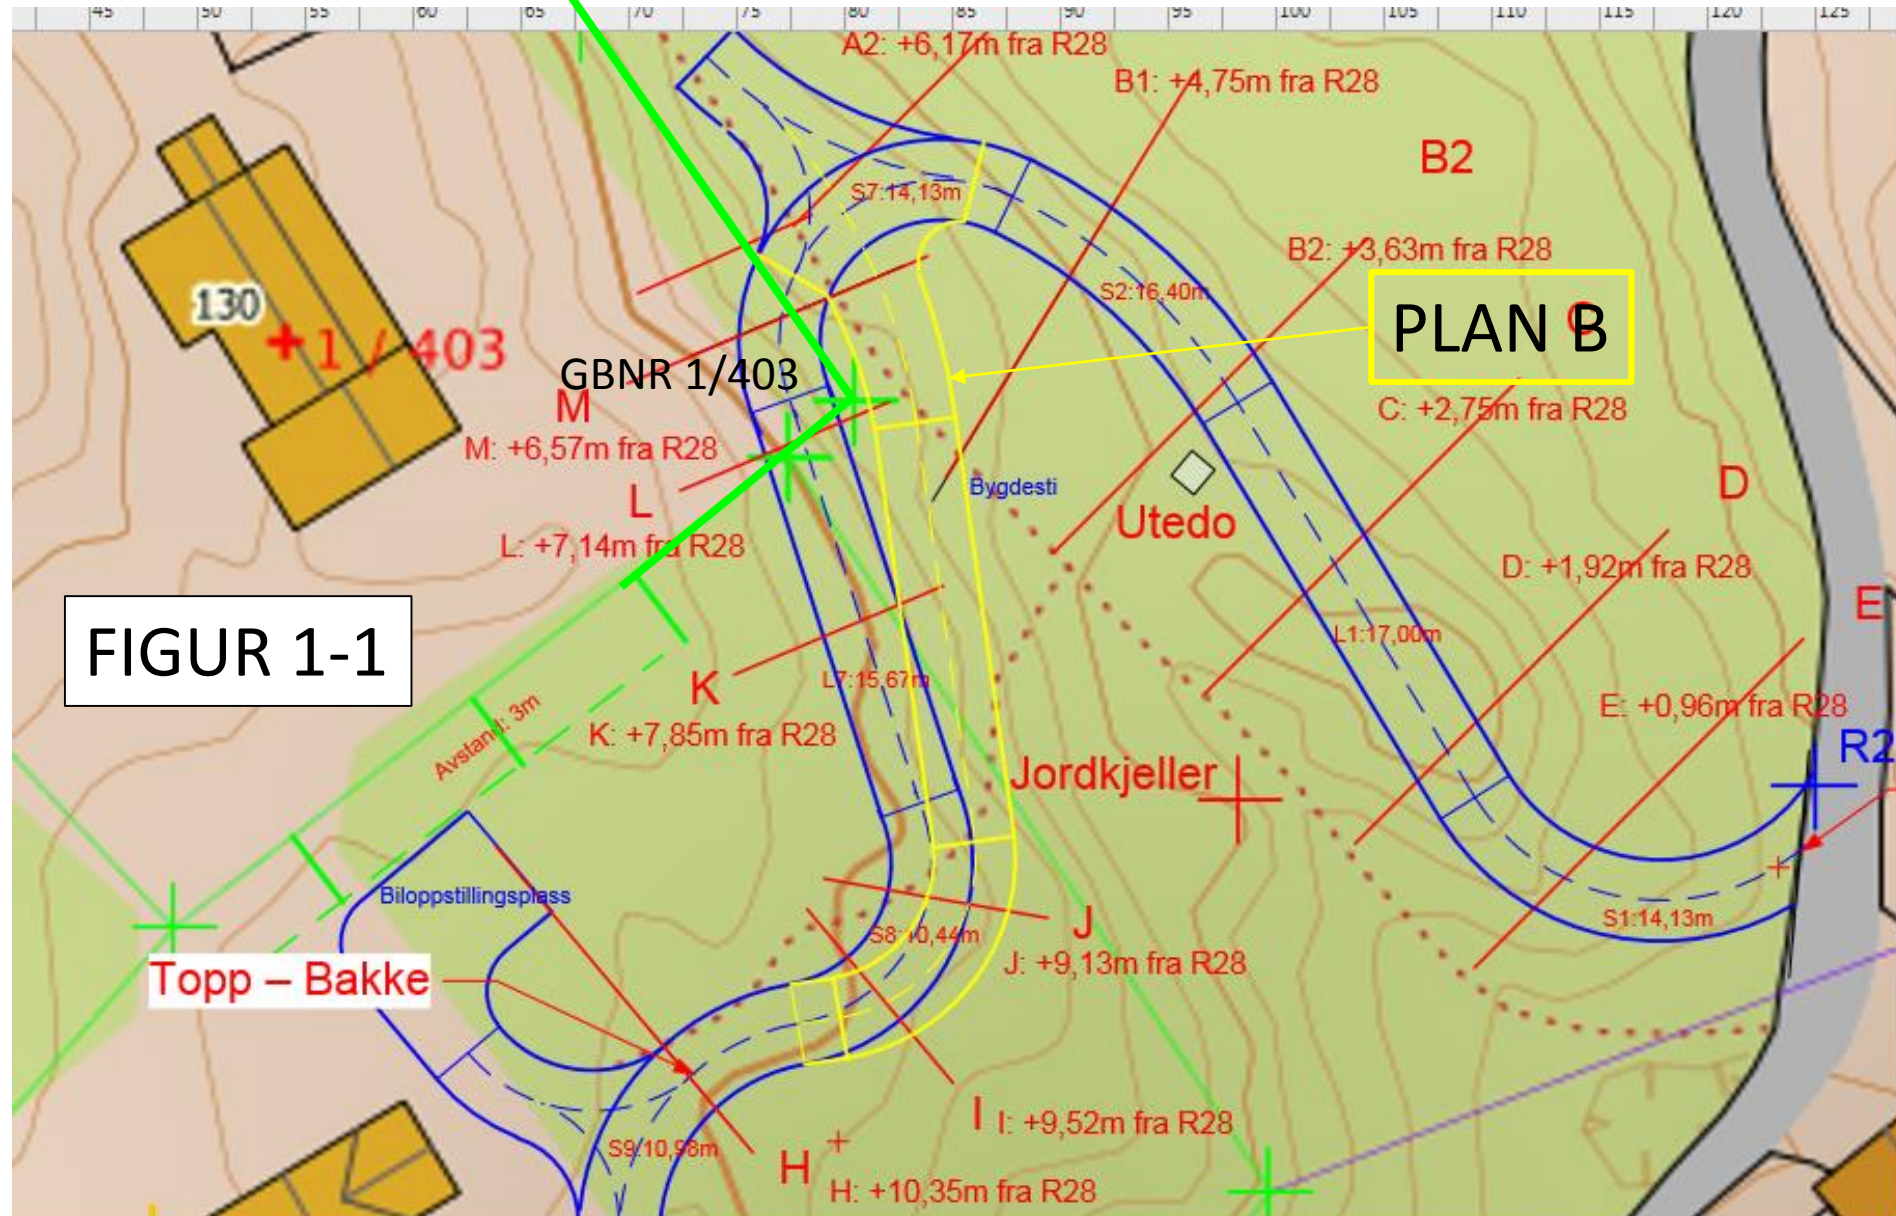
PLAN B – Alternative uten overkjøring på GBNR 1/403.
